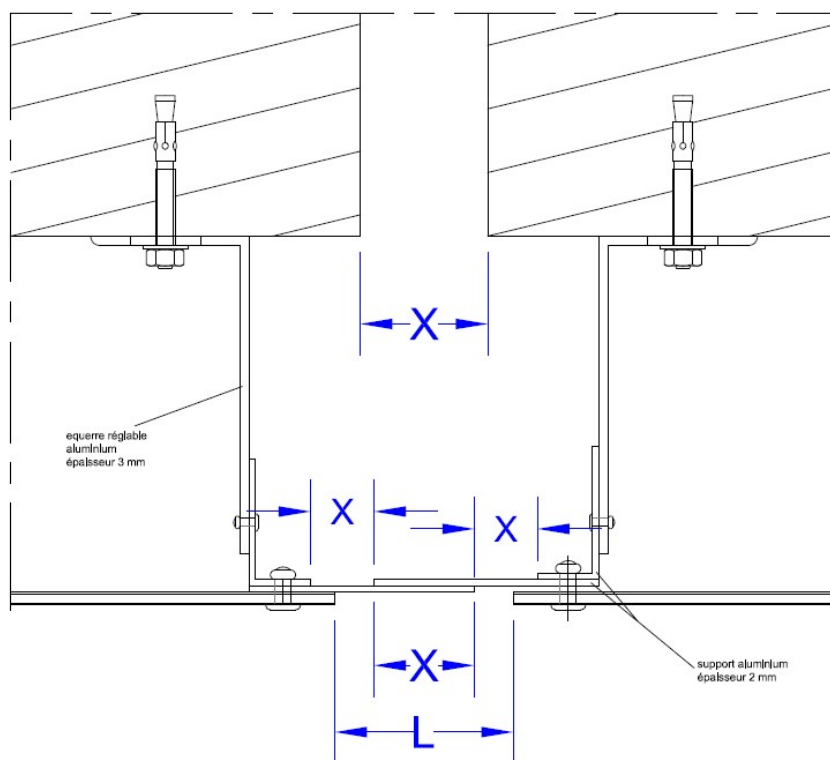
Arrêt latéral sur mur béton – Coupe horizontale
